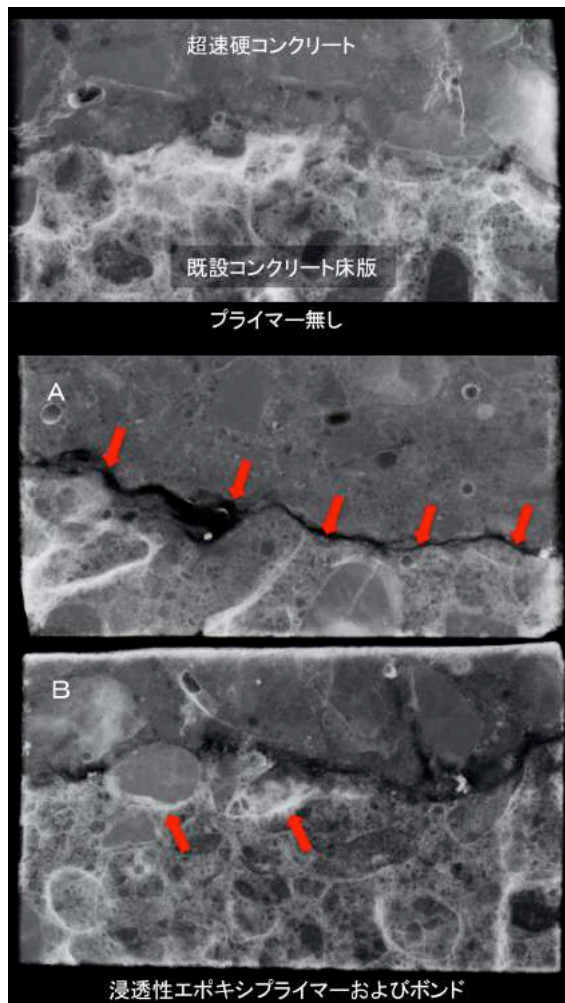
浸透性プライマーの有無によるコンクリート床版内部のひび割れ発生状況
